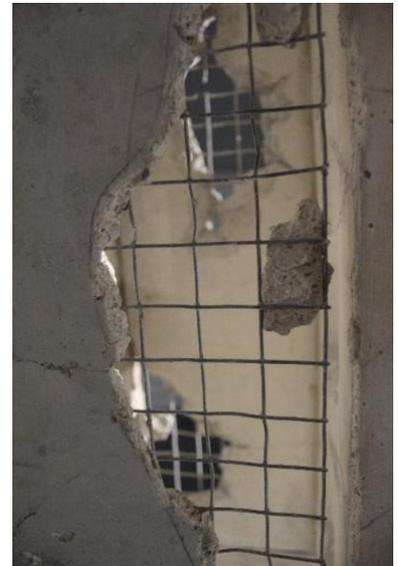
Detalle de una de las esculturas, imagen 8. Foto del autor.
